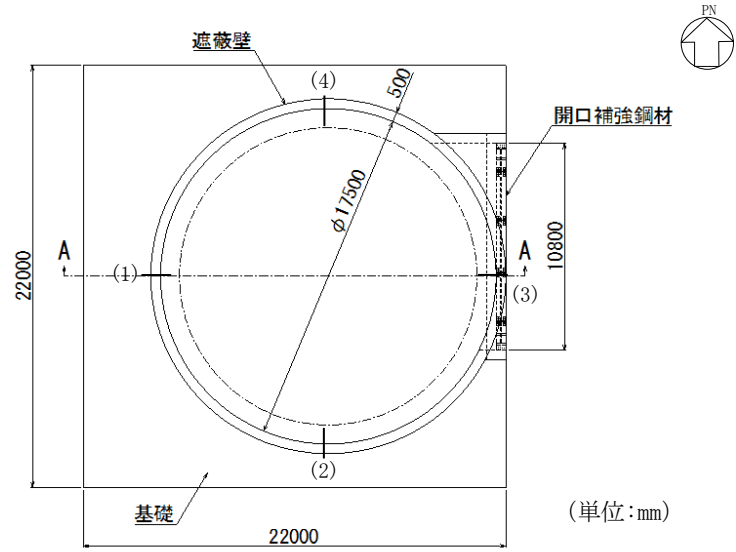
復水貯蔵タンク遮蔽壁 平面図
